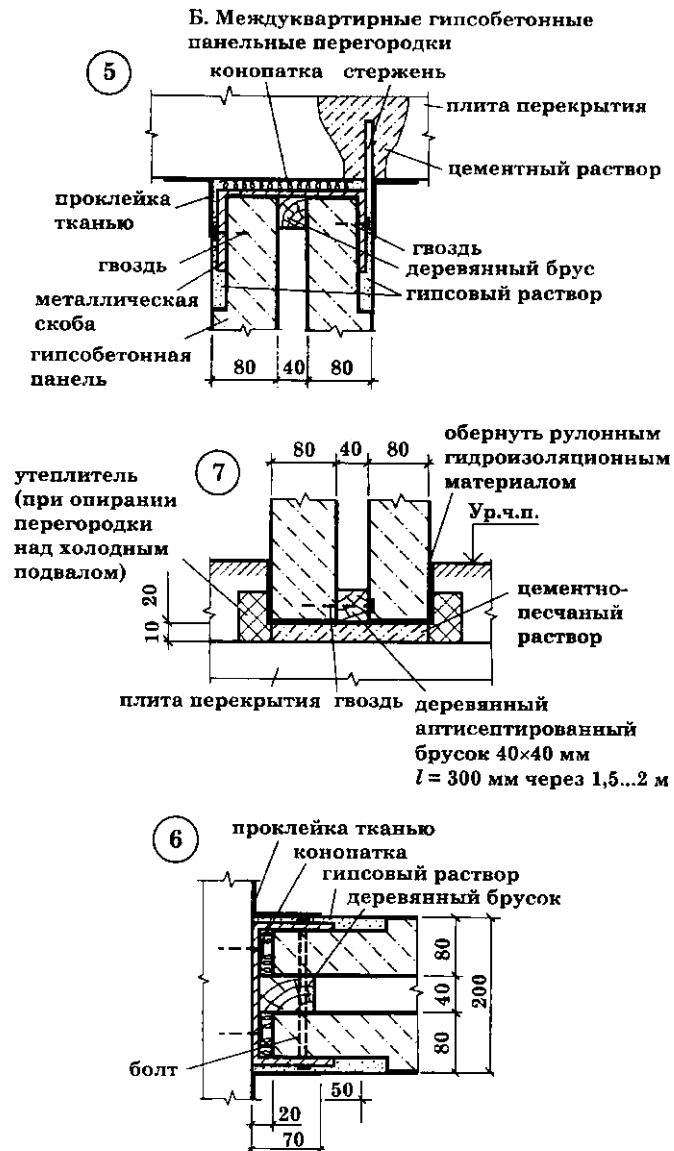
Междуквартирные гипсобетонные перегородки
